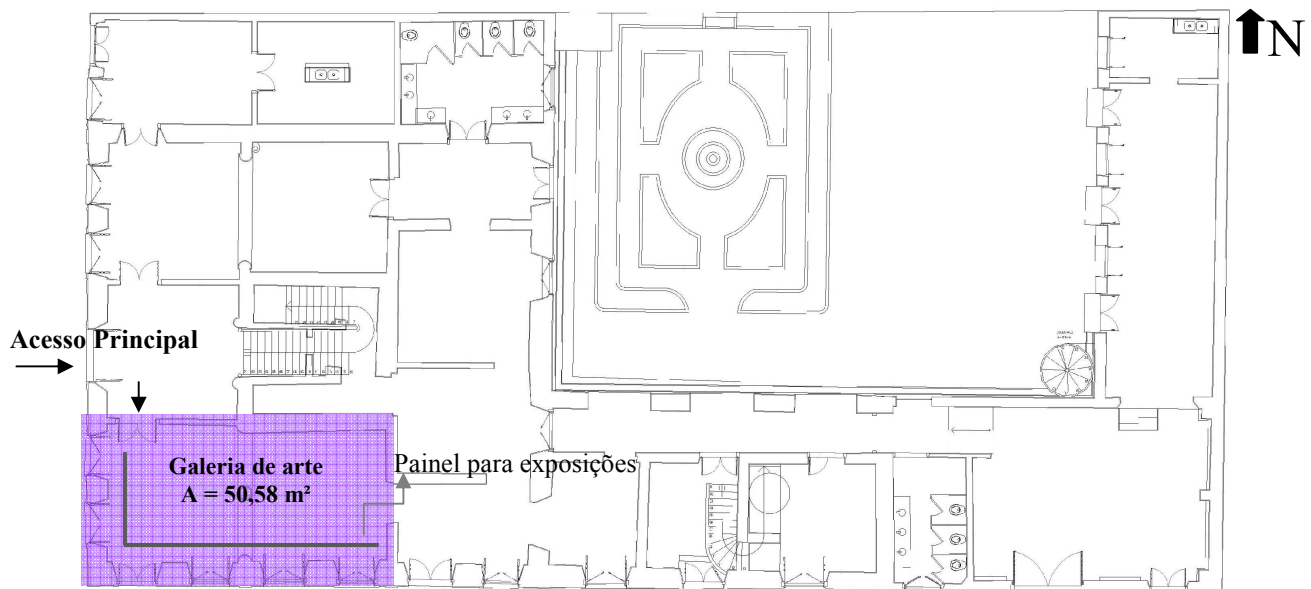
Planta baixa do pavimento térreo do casarão 02. Em destaque o ambiente selecionado para análise – Galeria de arte.
